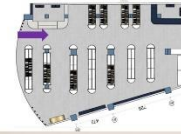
Layout Furnitur Ruang Terpilih 2
